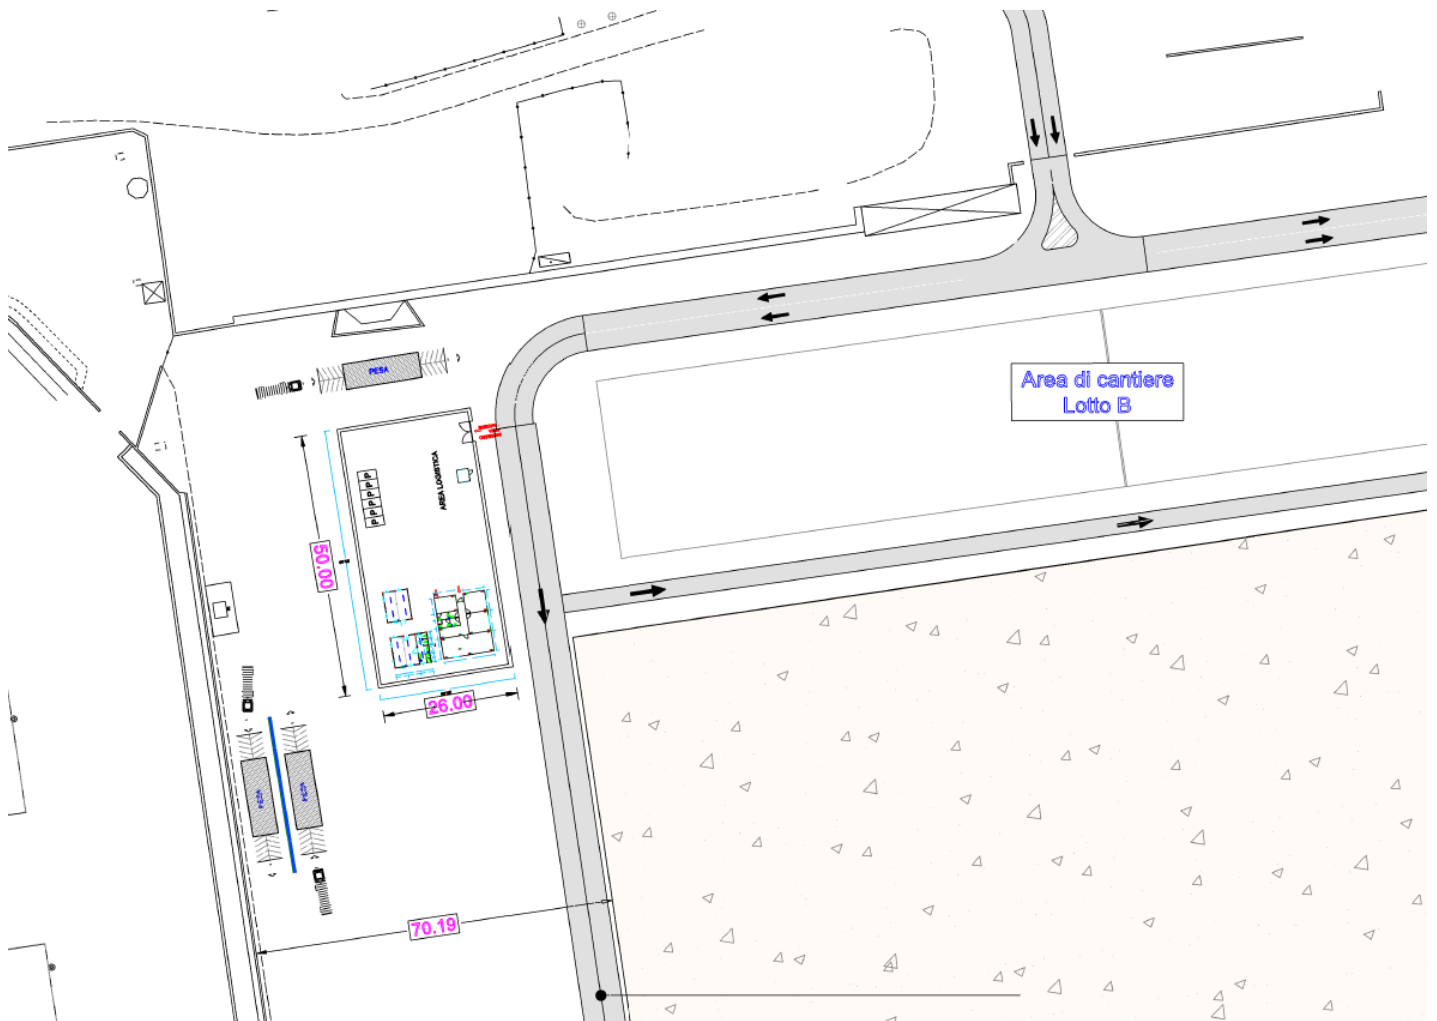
Planimetria di ubicazione dell'area logistica di cantiere
